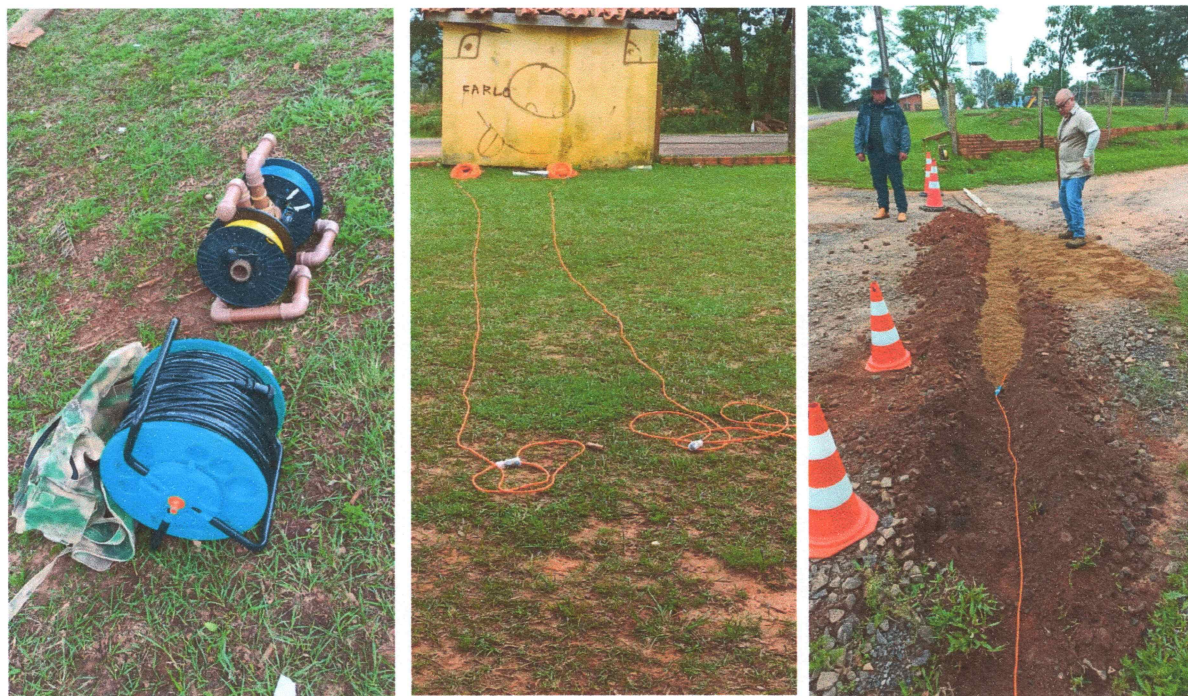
Instalação do cabeamento– Fonte: Autor.
